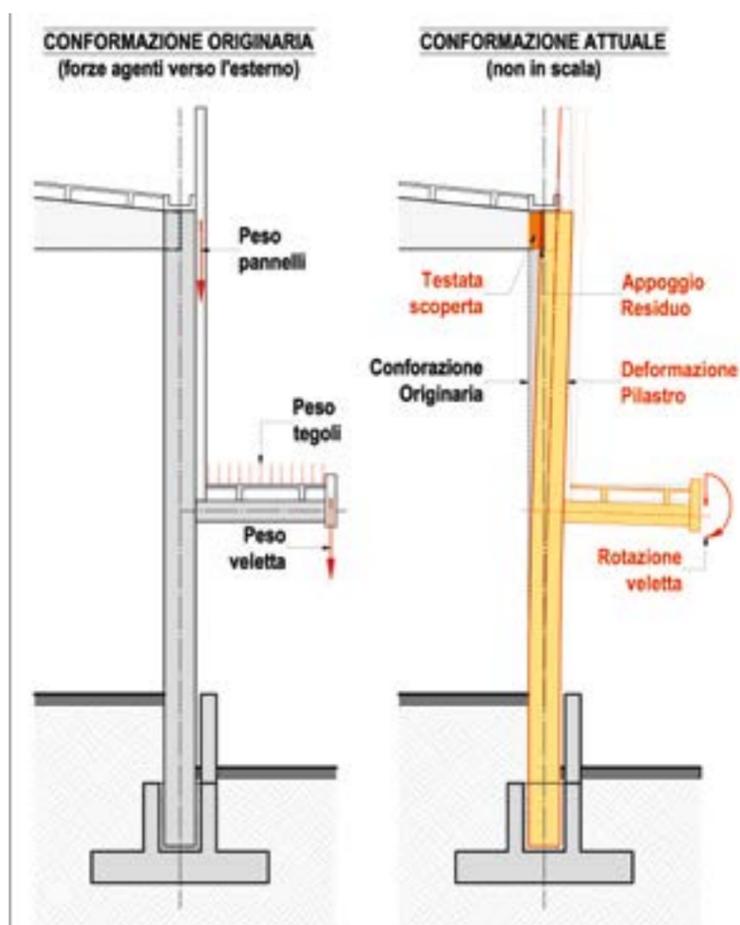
Deformazione pilastro: interpretazione qualitativa del fenomeno di flessione del pilastro, poi confermata numericamente.
